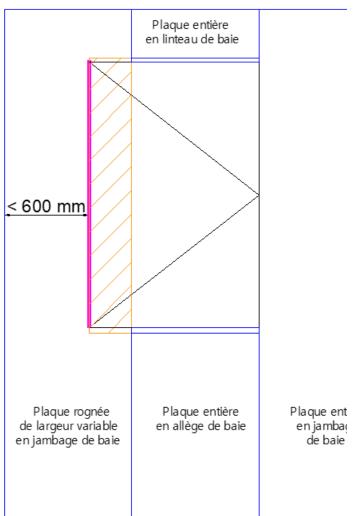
Encadrement d'une baie en tunnel avec plaque ajustée - Coupe Horizontale
